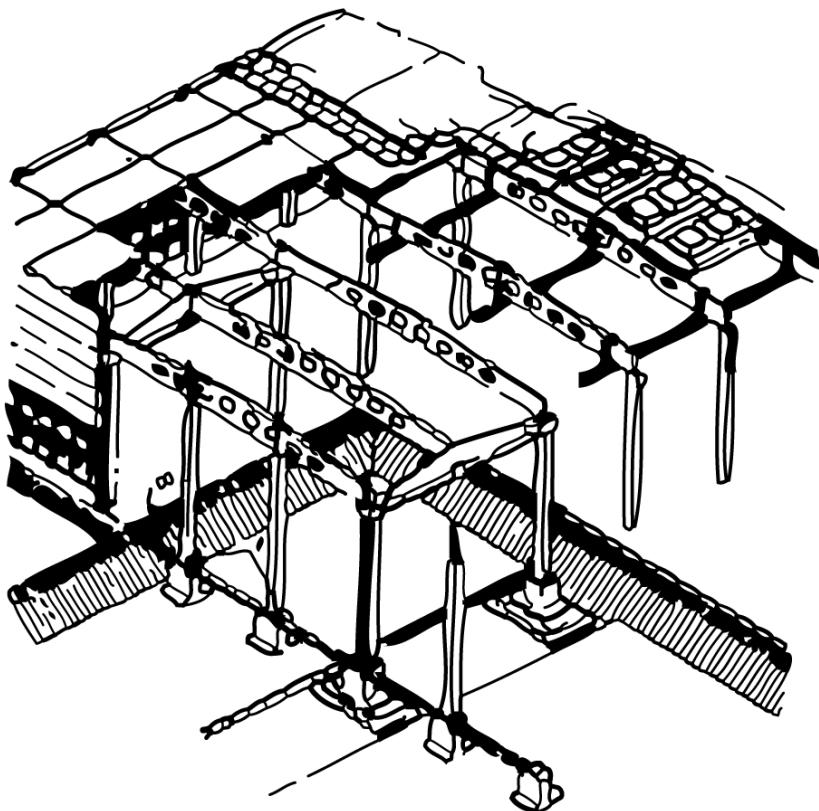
Монтаж перемычек для соединения металлической арматуры зданий.
